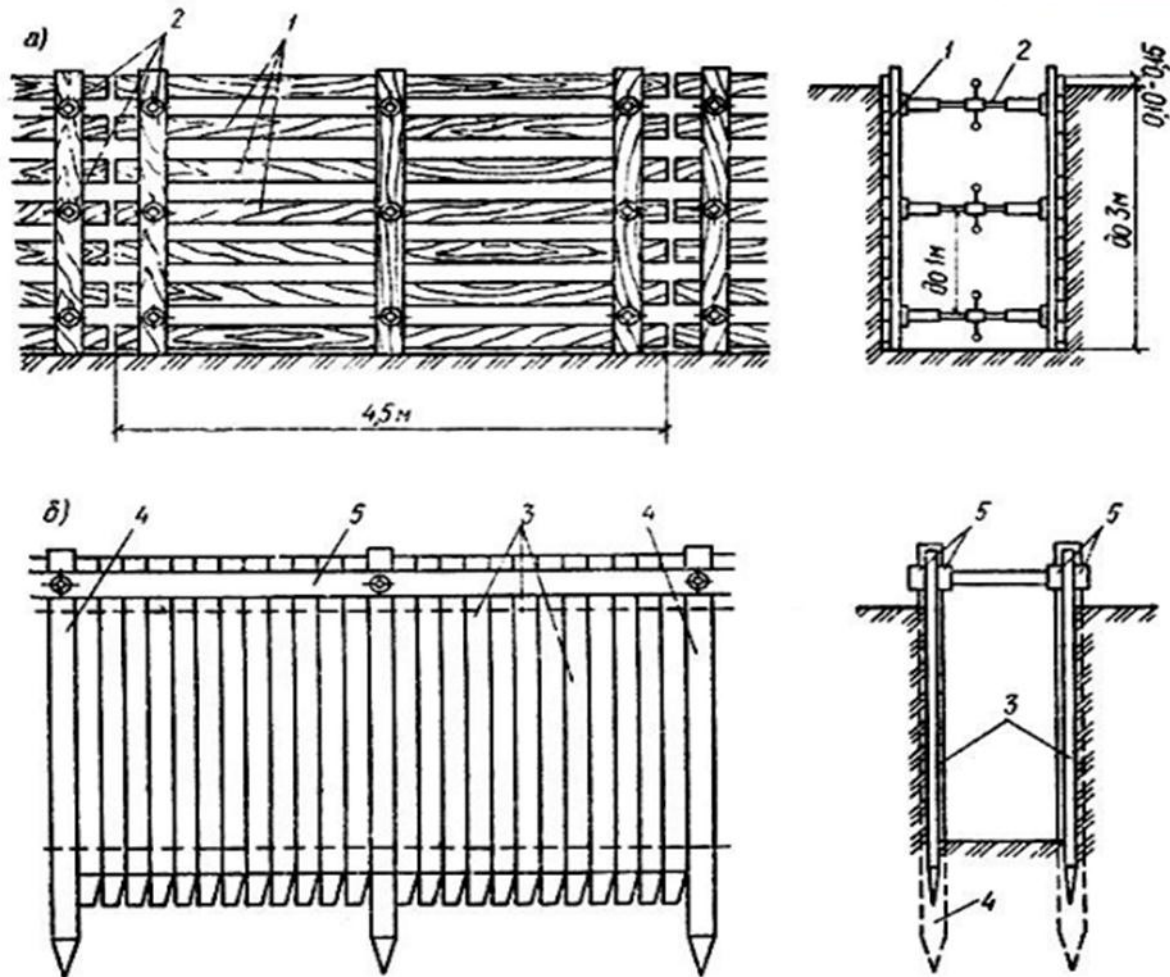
Кріплення стінок траншей: а – щитами з прозорами; б – шпунтовим рядом; 1 – доски з прозорами; 2 – розсувна інвентарна розпірка; 3 – дерев'яний шпунт; 4 – сваї; 5 – напрямні бруски
